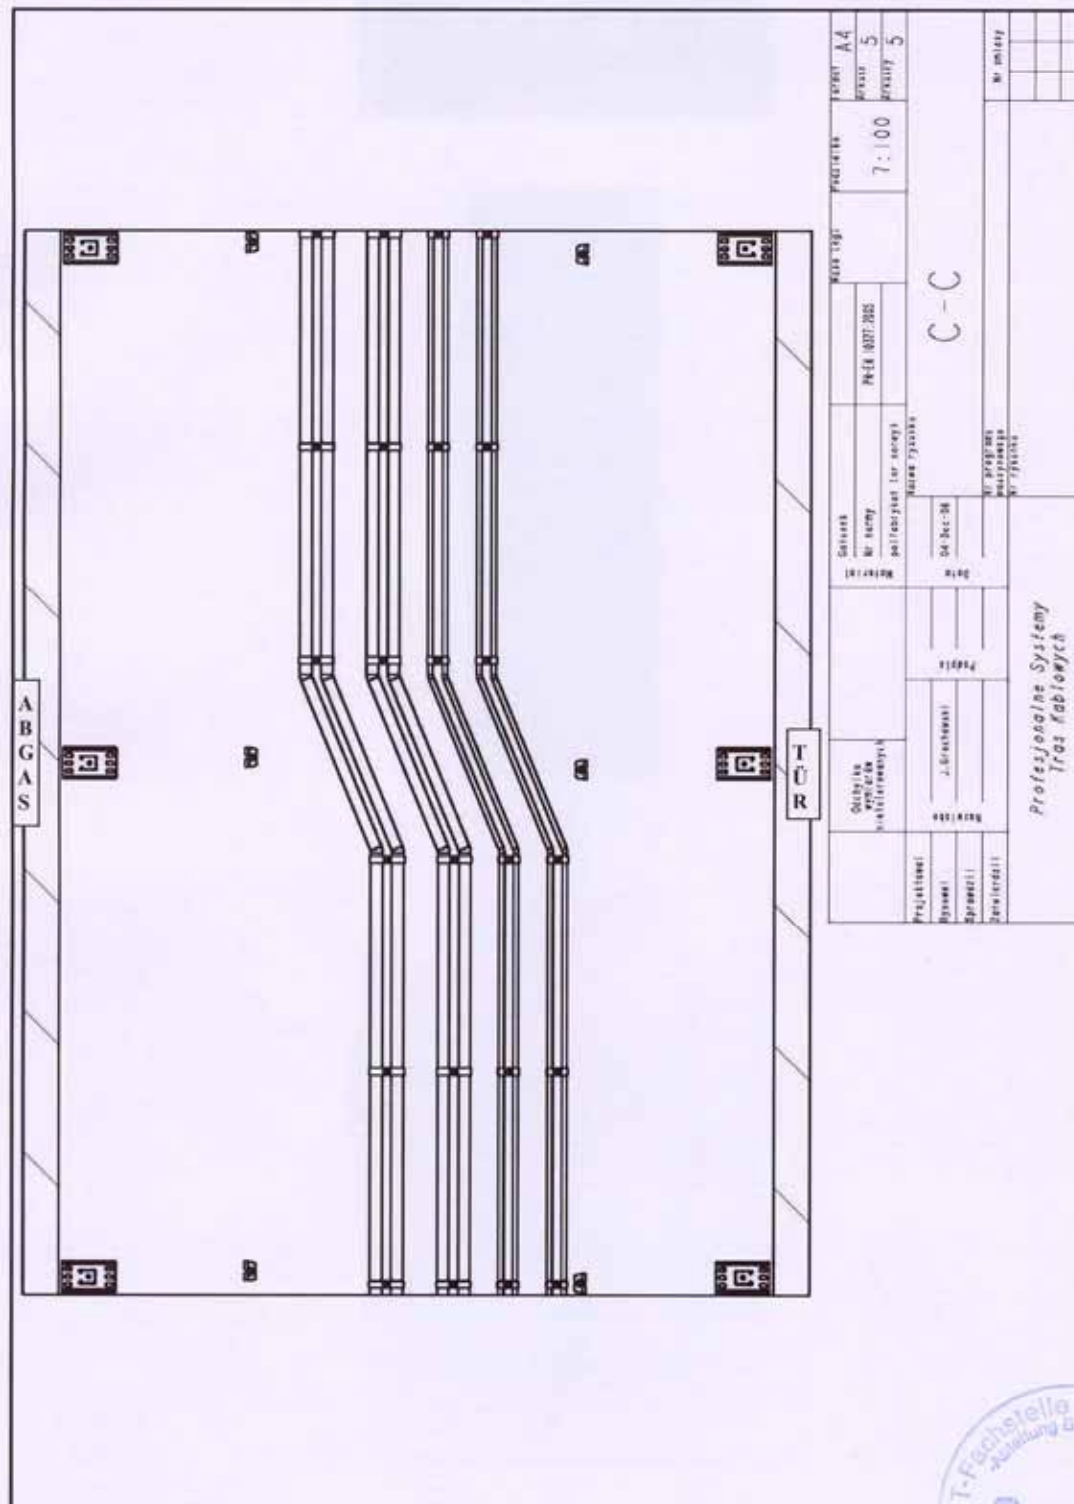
Grundriss der montierten Tragsysteme
